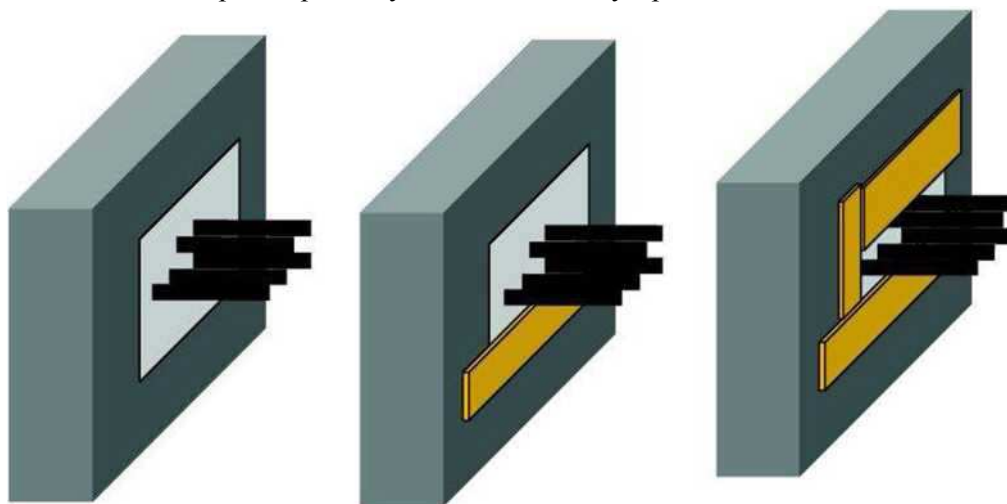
Схема монтажа опалубки при устройстве проходки в стене (перегородке)
